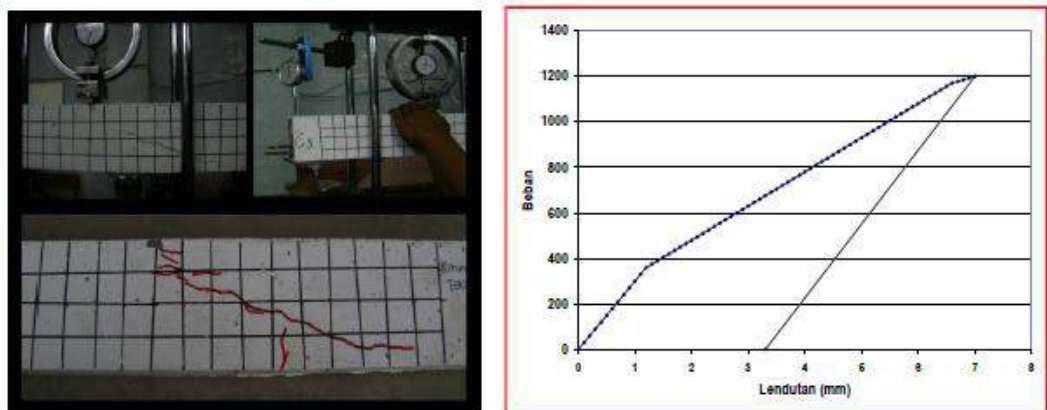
Benda Uji Balok Beton B3 dan Grafik Beban – Lendutan Balok B3
